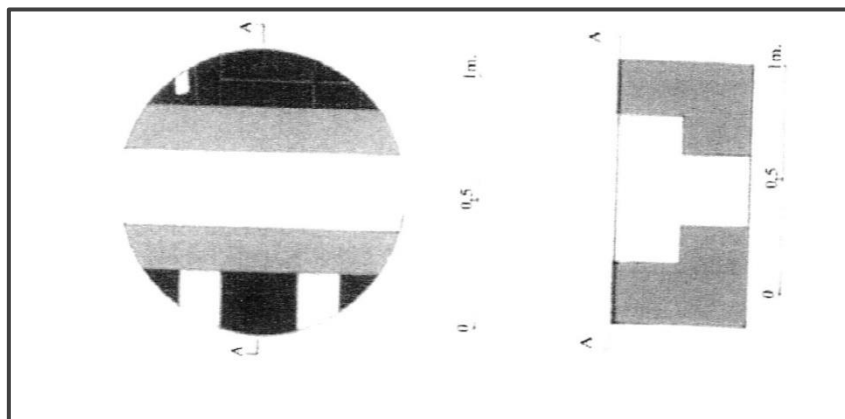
Creta 1. Planimetria e sezione del fonte battesimale (Mailis 2006, fig. 9, p. 298).
